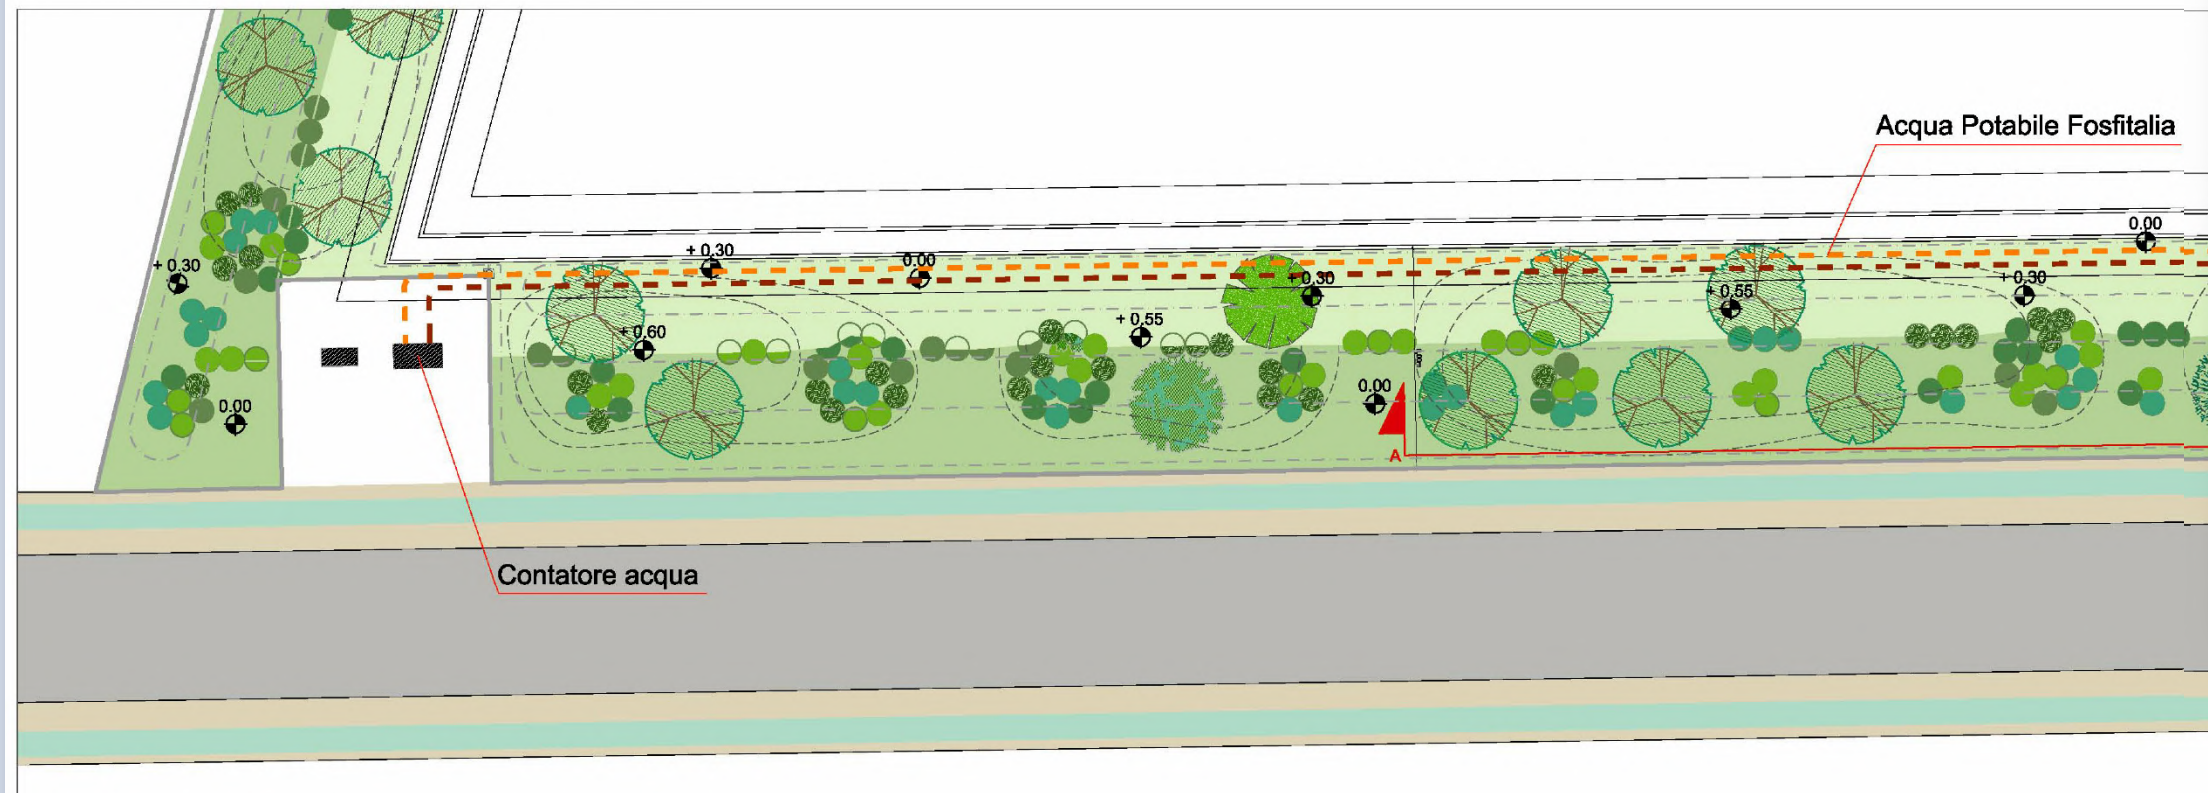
Foto A - STATO DI PROGETTO CON SISTEMAZIONE AVERDE - Foto B
